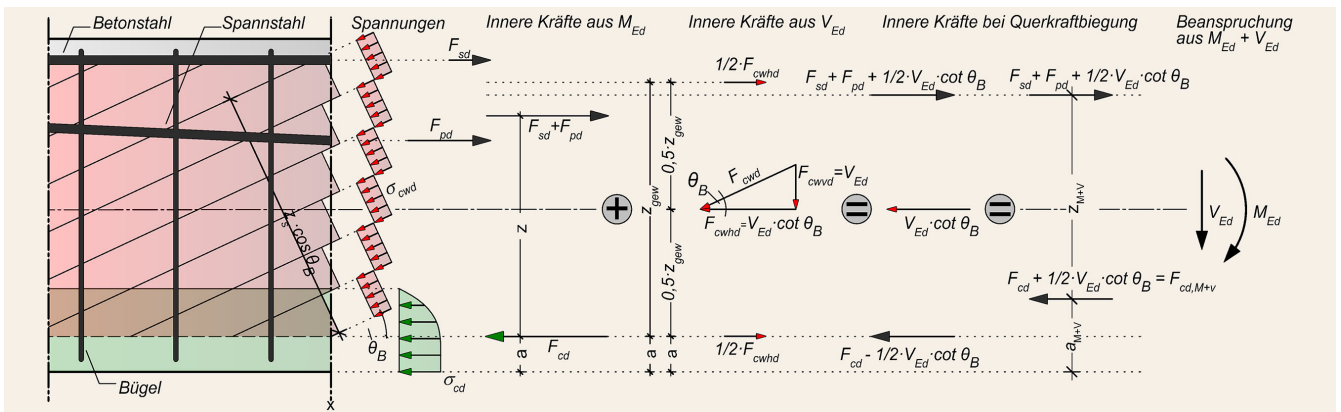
Idealisertes Fachwerkmodell eines Spannbetonbalkens bei Querkraftbiegung im B-Bereich mit negativem einwirkendem Biegemoment
